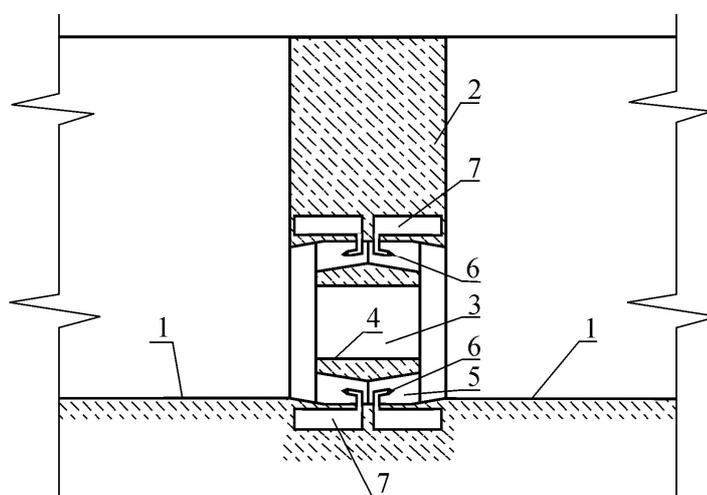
Схема гидравлического затвора на разрезе: 1 – рыбоходный тракт; 2 – вертикальная поперечная разделительная стенка; 3 – вливное отверстие; 4 – потокоформирующий фартук; 5 – транзитные галереи; 6 – струеобразующие насадки; 7 – напорные коллекторы
